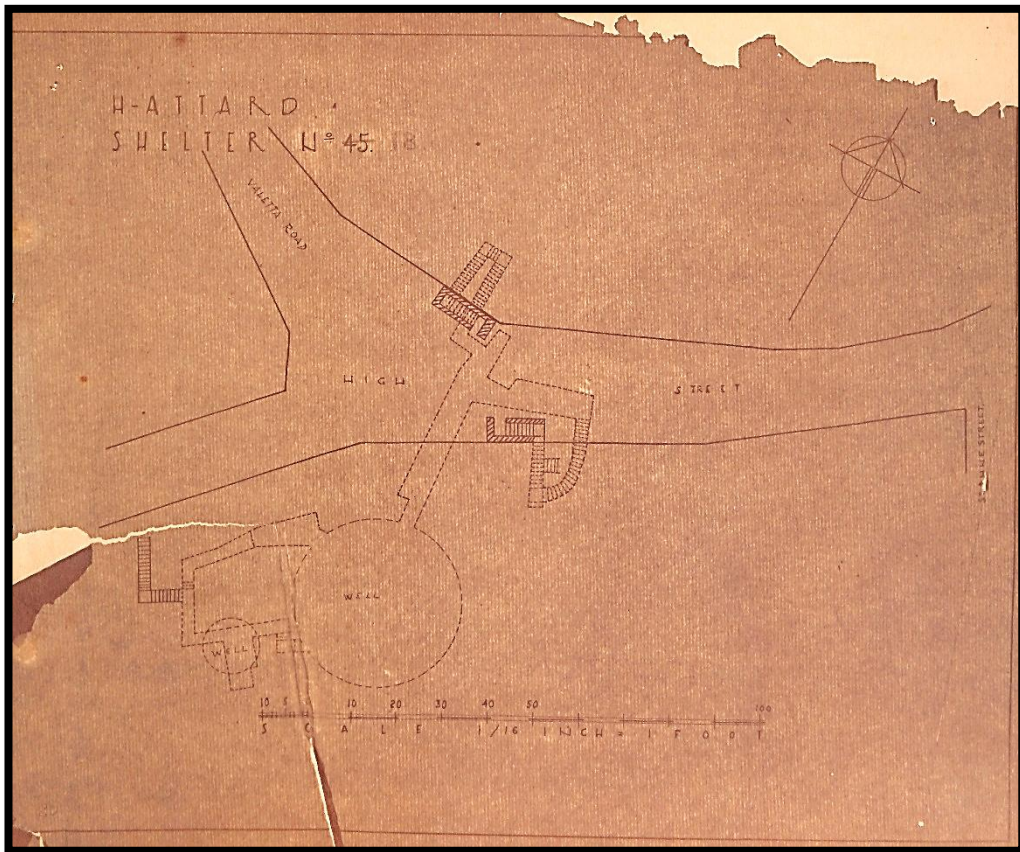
Planta do Abrigo nº18 (45) "High Street – Valletta Road."
